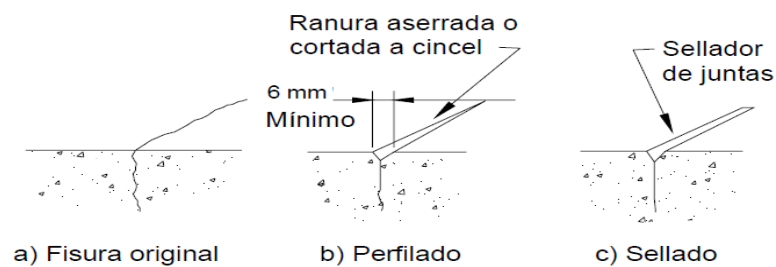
Reparación de una fisura mediante perfilado y sellado.
